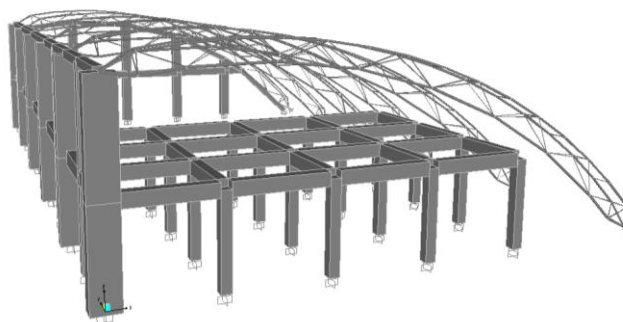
Detalle de secciones de concreto y acero en programa SAP200.
